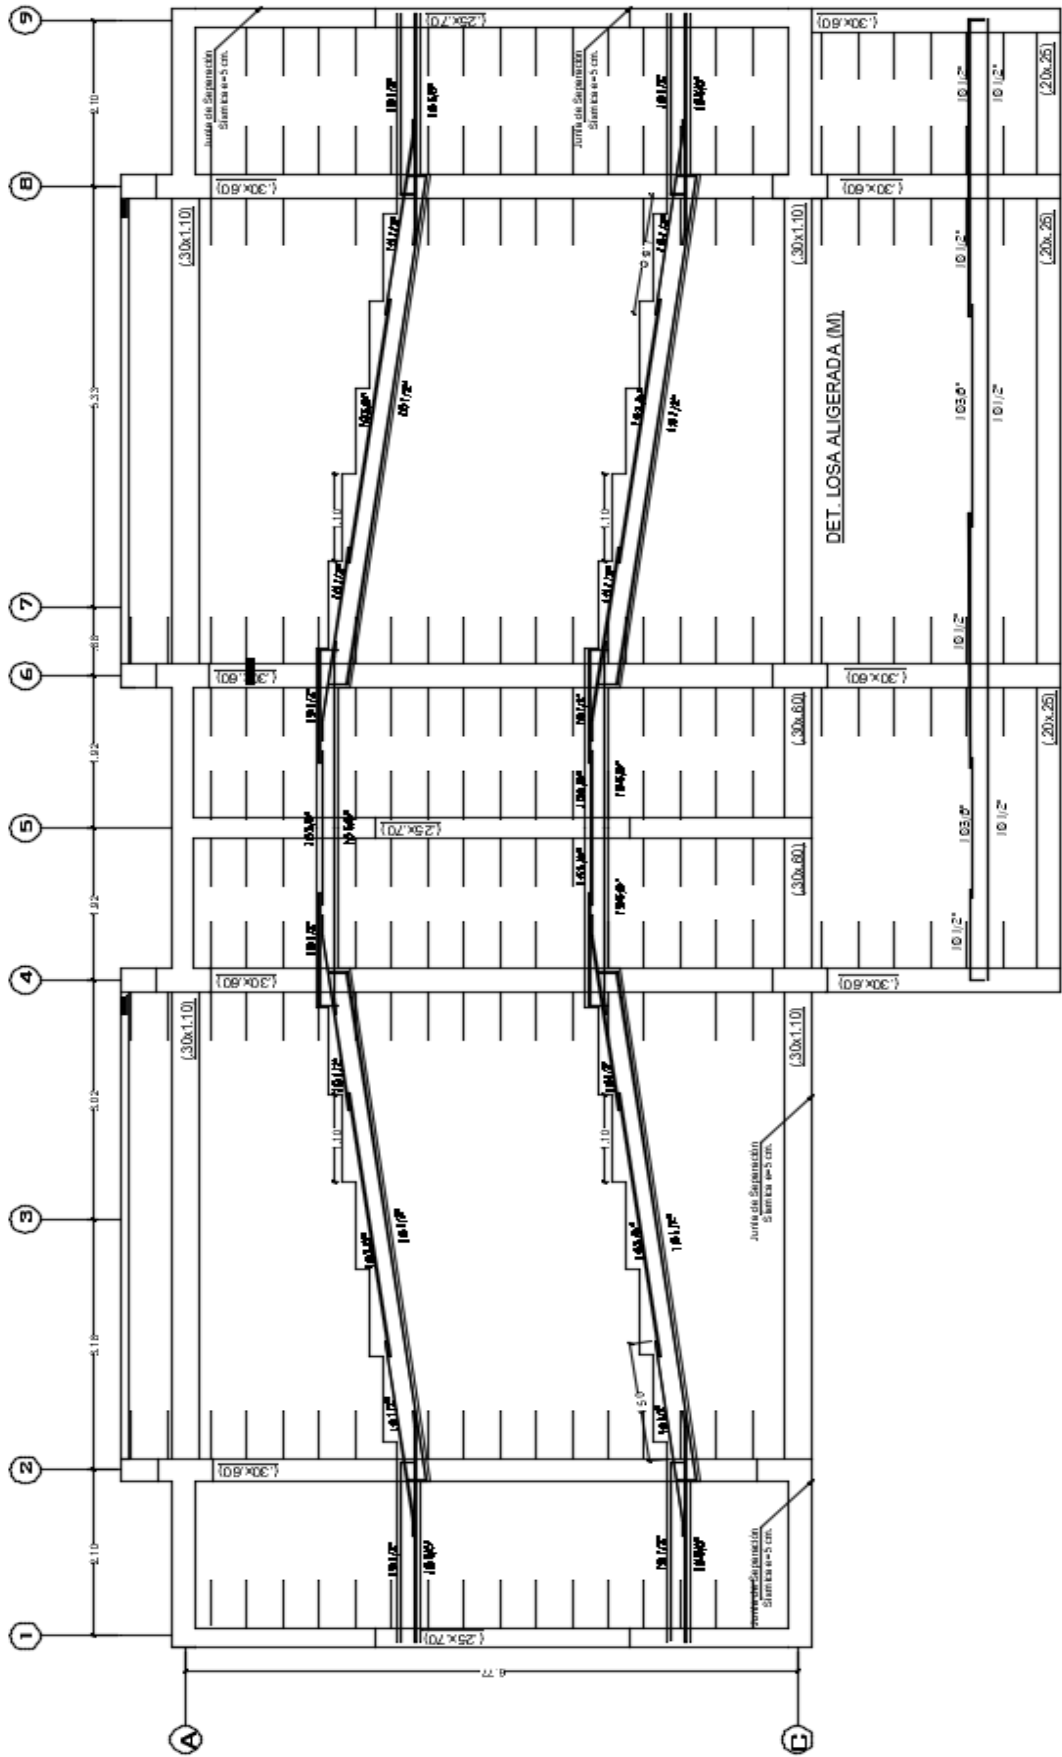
26.- Diseño final losa aligerada (BLOQUE 1)
